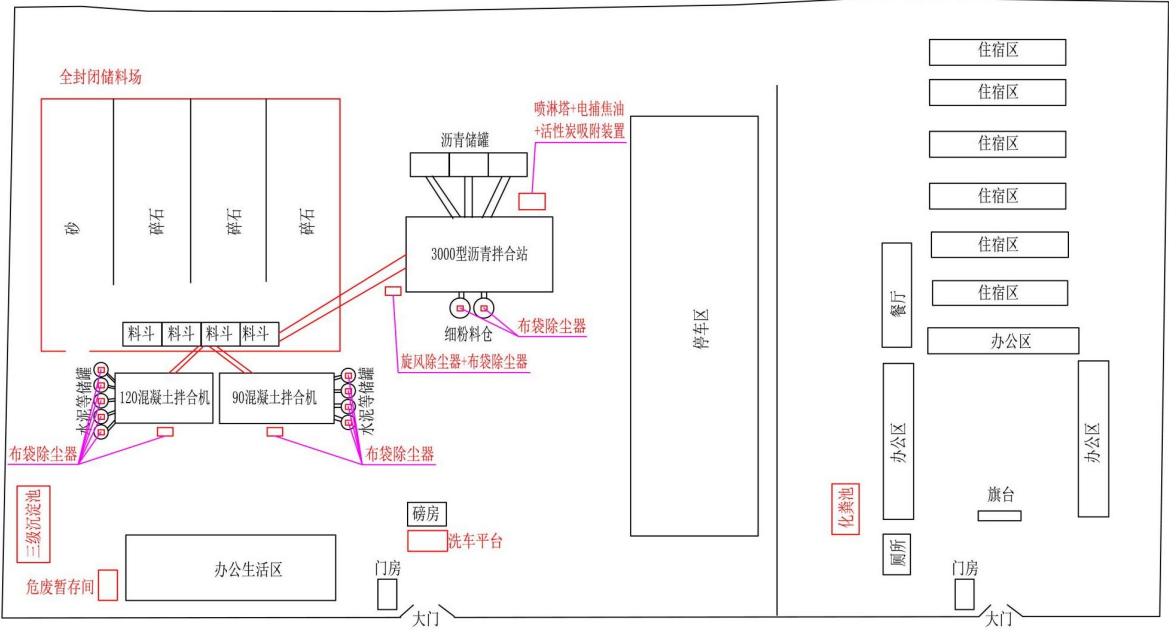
典型混凝土拌合站及沥青拌合站平面布置图
